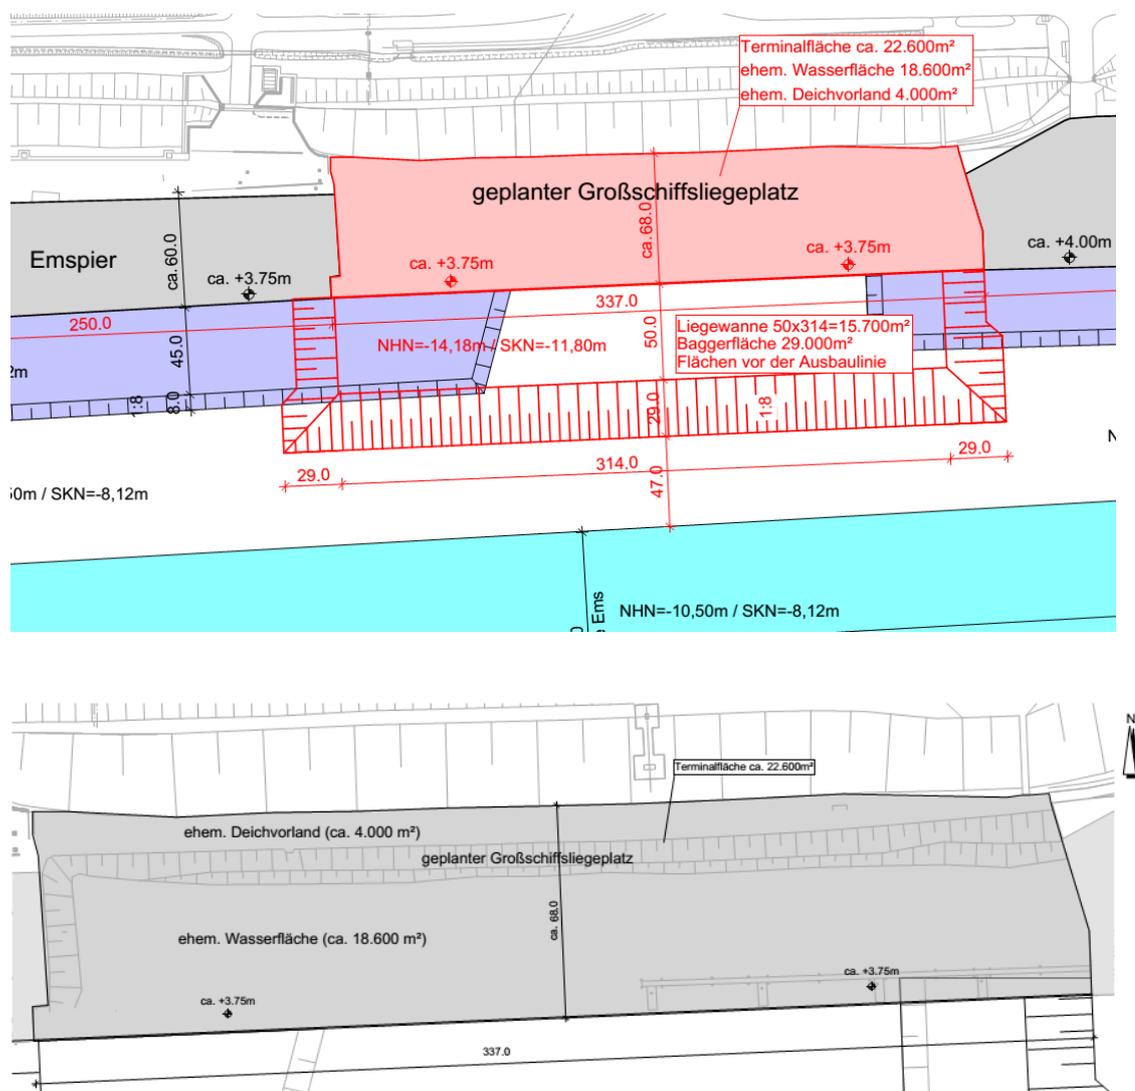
Ausschnitte Lageplan (SE15057-GP-300_Übersichtslageplan)
